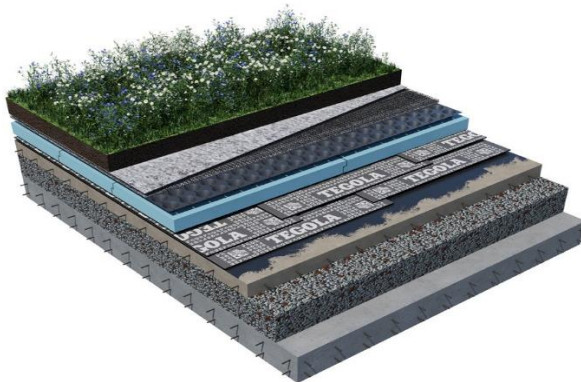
Устройство слоев перекрытия при организации зимнего сада
